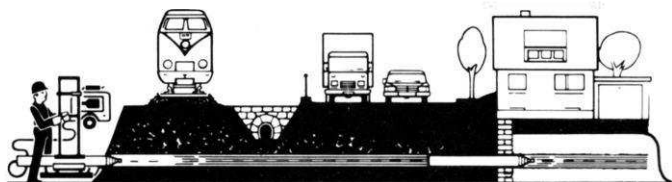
Passage sous route ou voie ferrée avec la fusée Grundomat.
